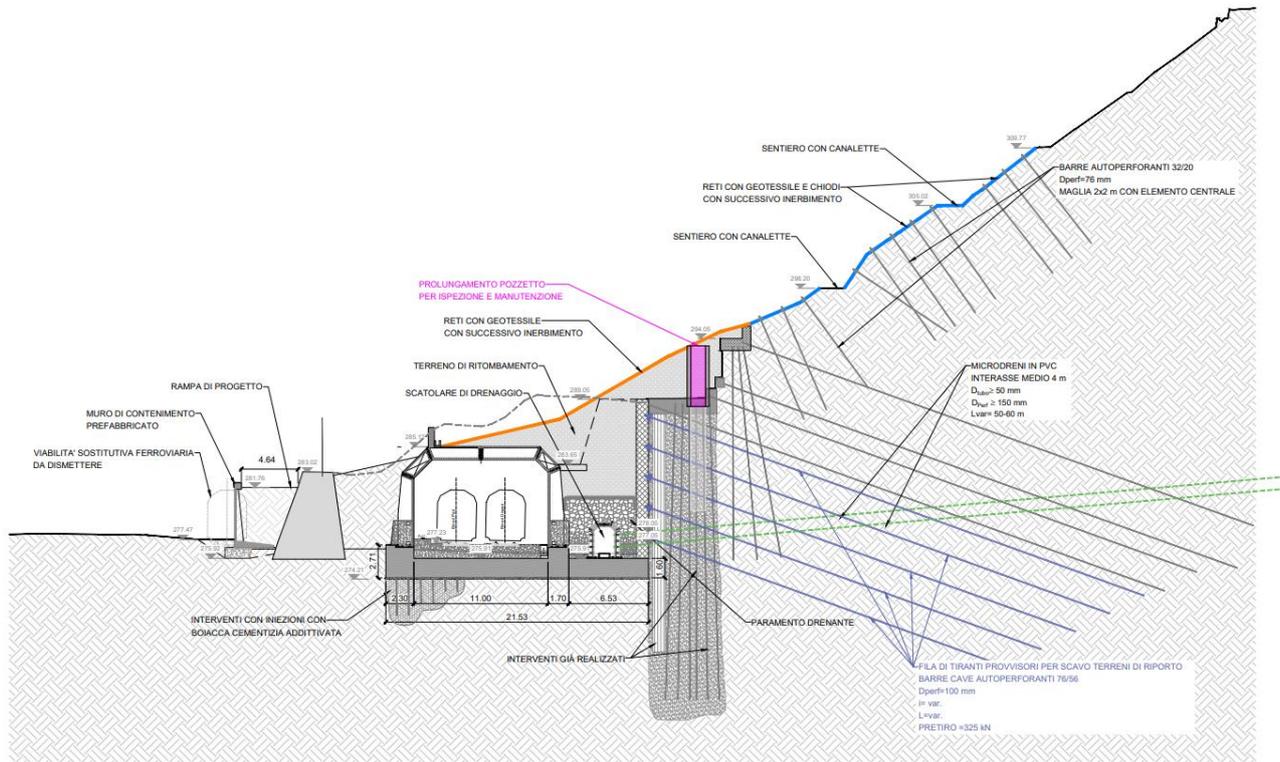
Stralcio di una sezione di intervento sul muro crollato consolidato.
